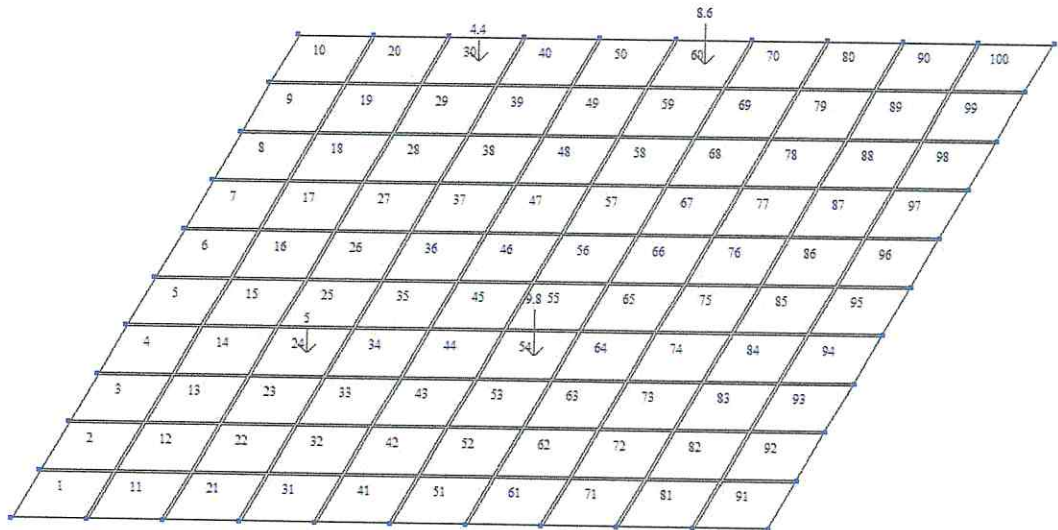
Нагрузка на плиту перекрытия шахты от лифтового оборудования.
